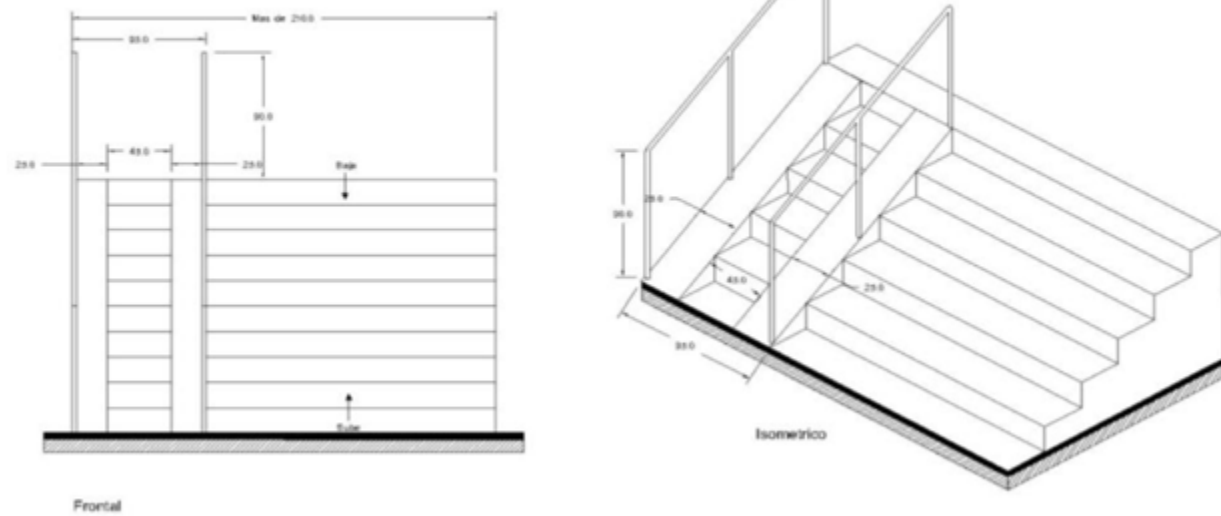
C. Rampa ciclista y para carreolas en escaleras con un ancho mayor a 2.10 m.
